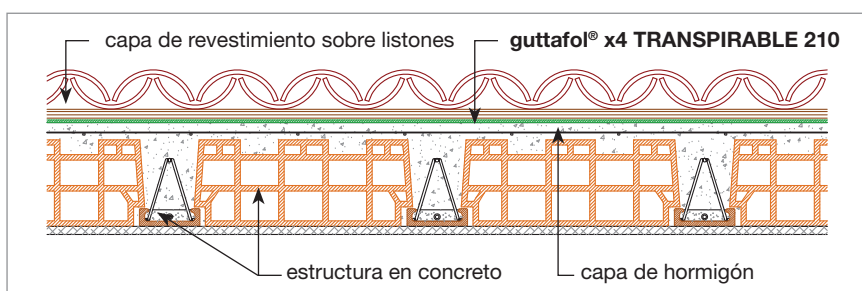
guttafol® x4 TRANSPIRABLE 210 colocado directamente sobre la capa de hormigón sin cámara de ventilación
